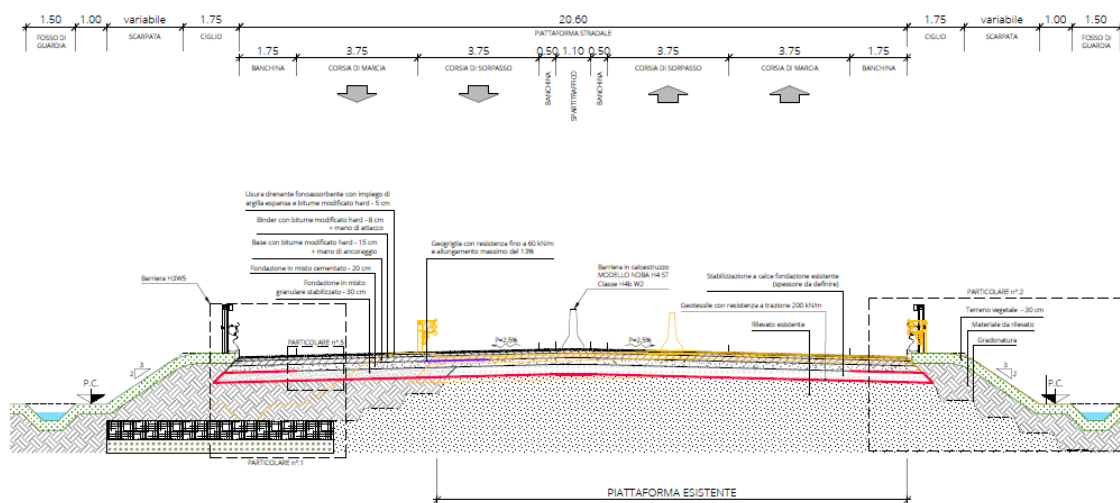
Sezione tipo in rilevato – Viabilità di progetto SS16 – cat. B con spartitraffico ridotto
